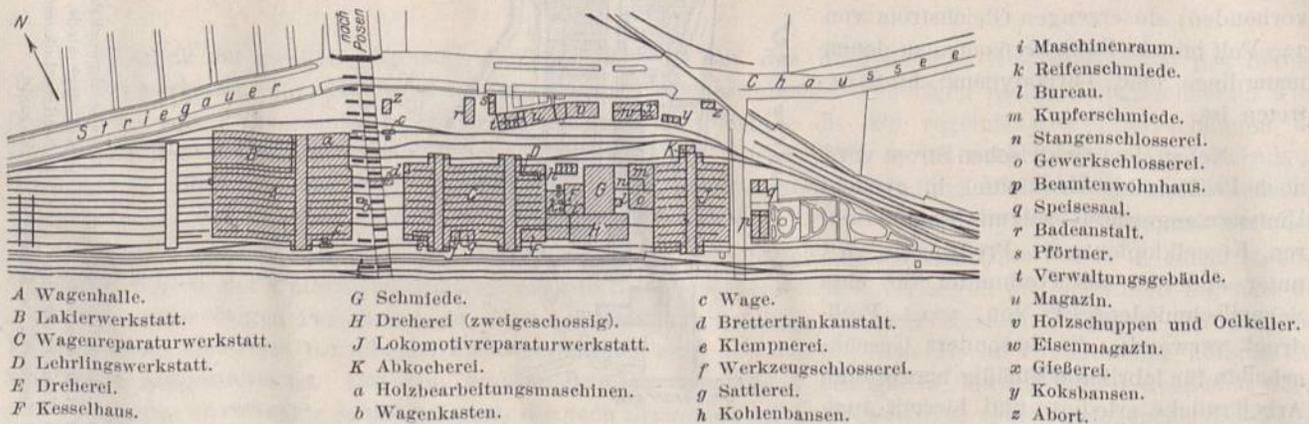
Lageplan der Hauptwerkstatt (Breslau Märkisch). 1 : 5000.
